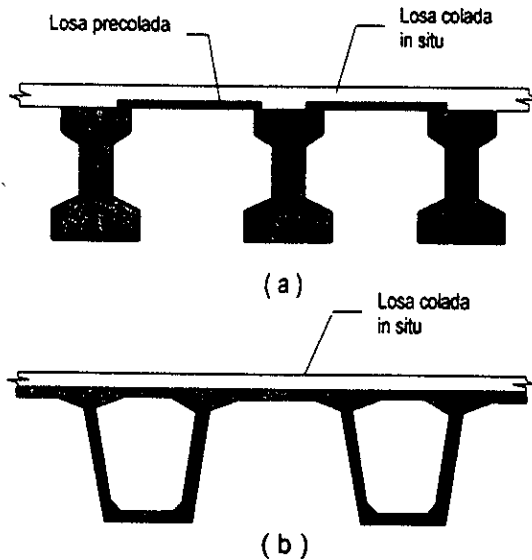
Solución estructural común: (a) utilizando una viga I estándar tipo AASHTO, (b) solución mediante el empleo de vigas cajón.
